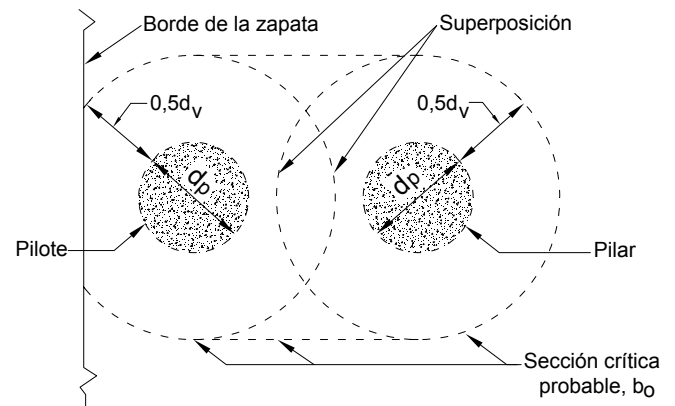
Sección crítica modificada para corte con perímetros críticos que se superponen
